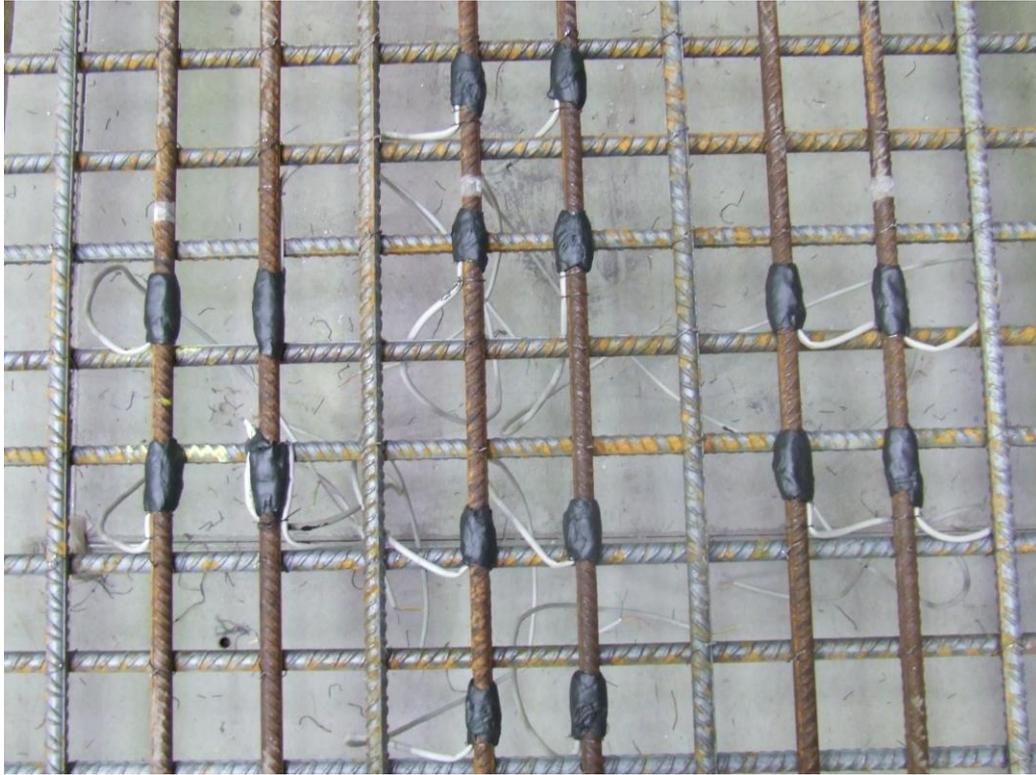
Obere Bewehrungslage mit DMS – Versuchskörper ED
